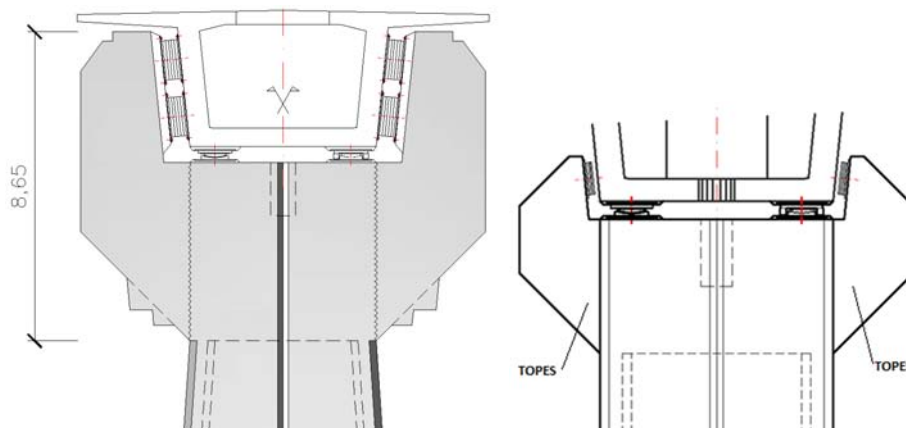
, 5b. Tope transversal en pila delta. Topes transversales en pilas tipo.
